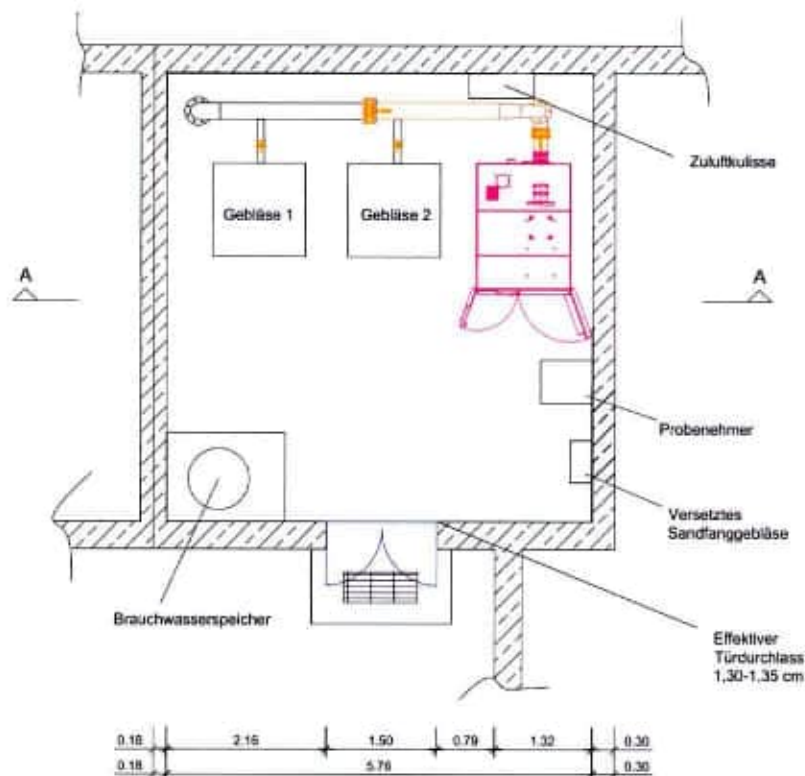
Grundriss der geplanten Gebläsestation
